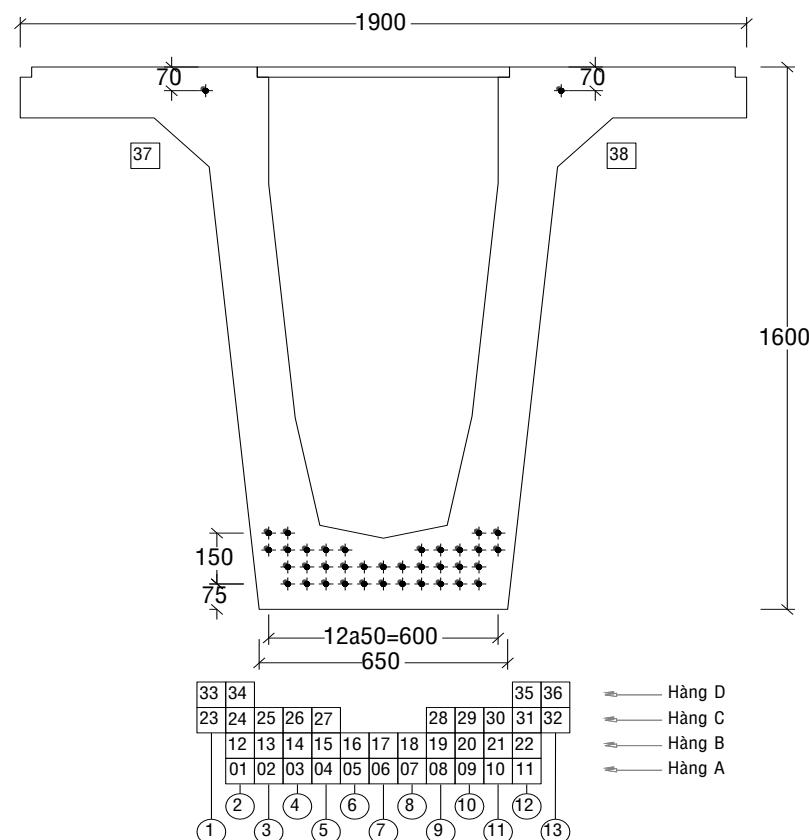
Bố trí cốt thép tại mặt cắt 3/10 nhịp
